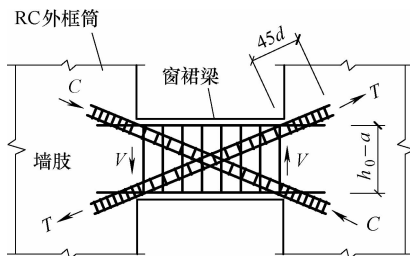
钢筋混凝土框筒窗裙梁的抗震配筋
